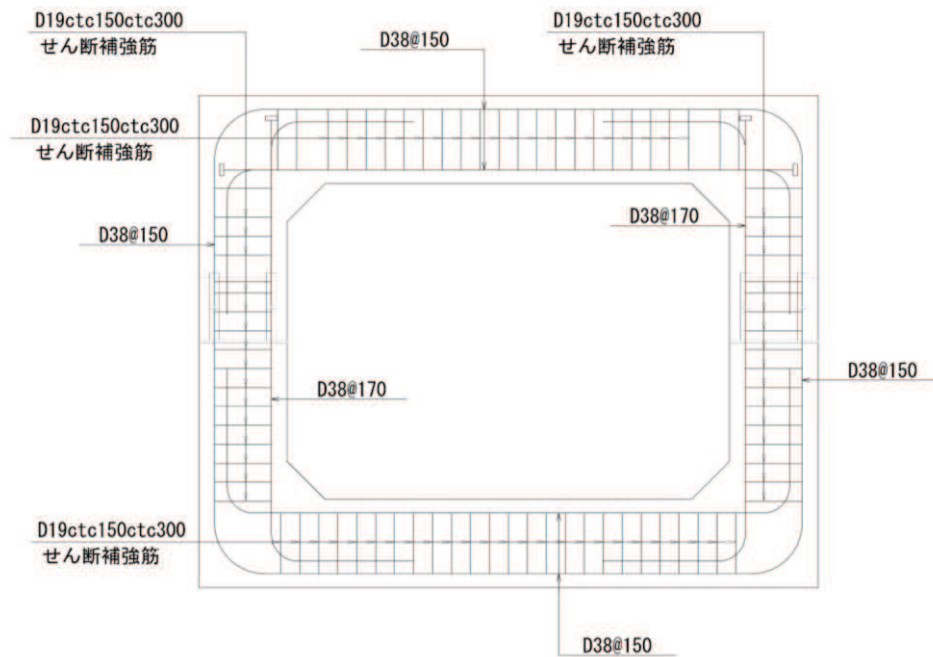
北側排水路の概略配筋図 (A-A 断面, B-B 断面共通)
